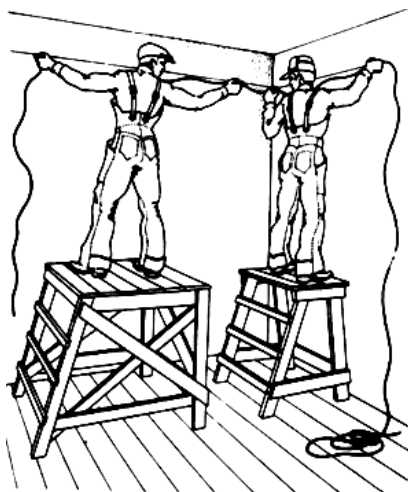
Разметка и отбивка на стенах и потолке линий трассы электропроводки
